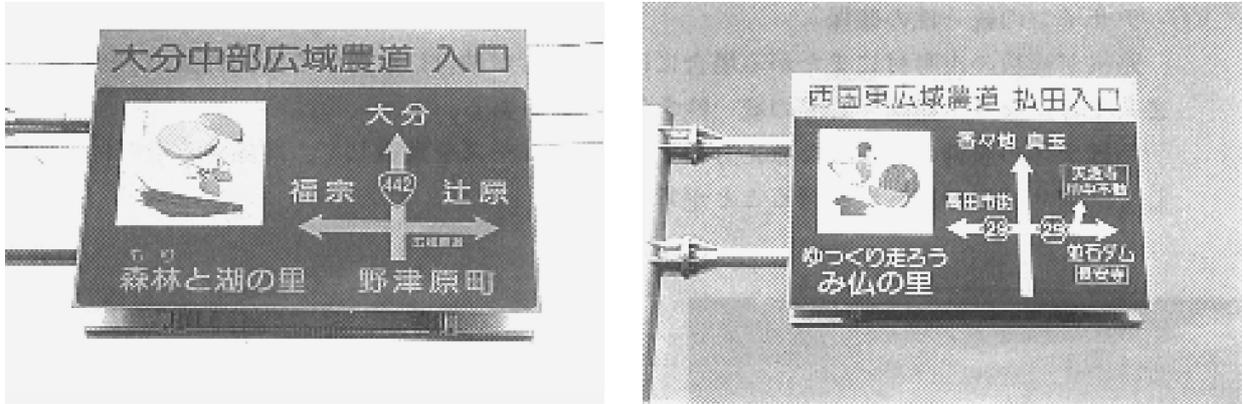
広域的にイメージ統一した案内標識の例 (1) (大分県)
